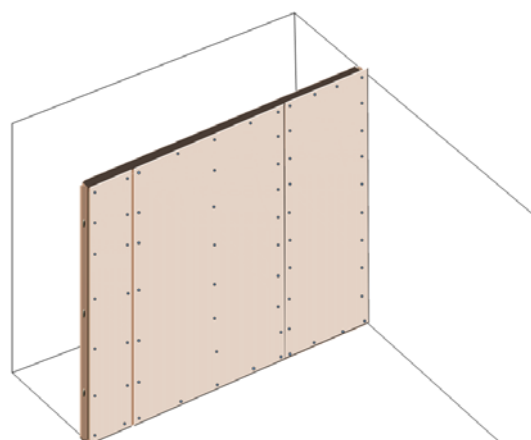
Componentes dos Sistemas Construtivos em Drywall
